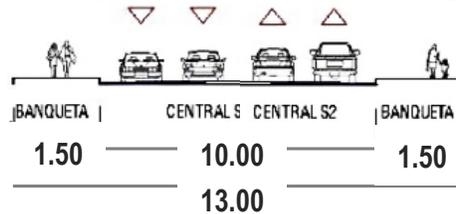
Vialidad local, C. Hacienda de Chapingo.
